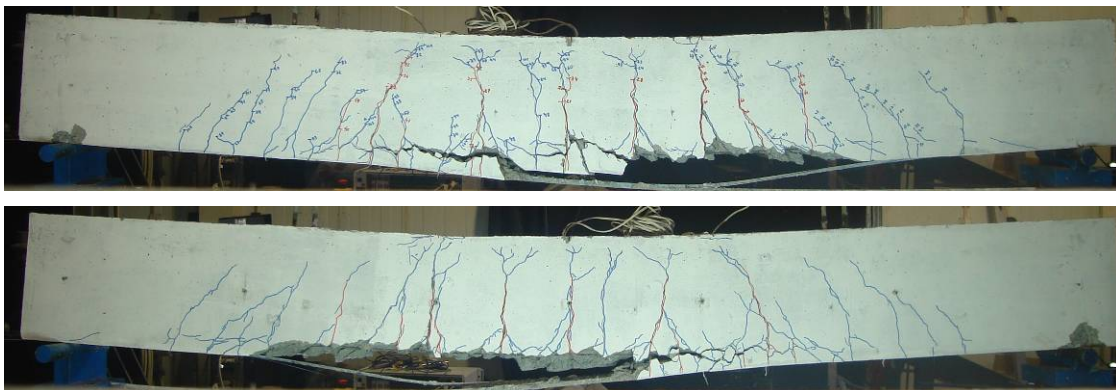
Padrão de fendilhação final instalado na viga S2-PC2.
